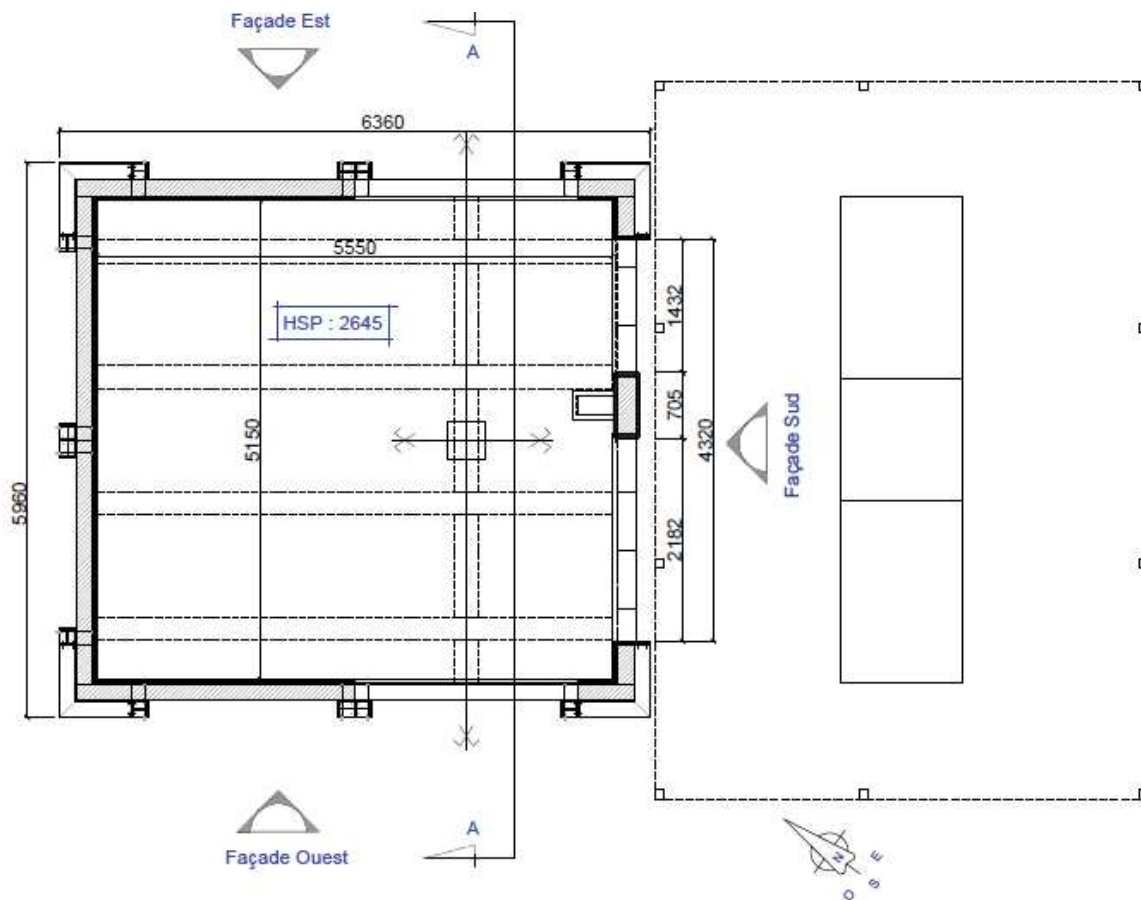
Vue en plan de la cellule d'essai pour l'essai 3 (poteau/poutres LC)
